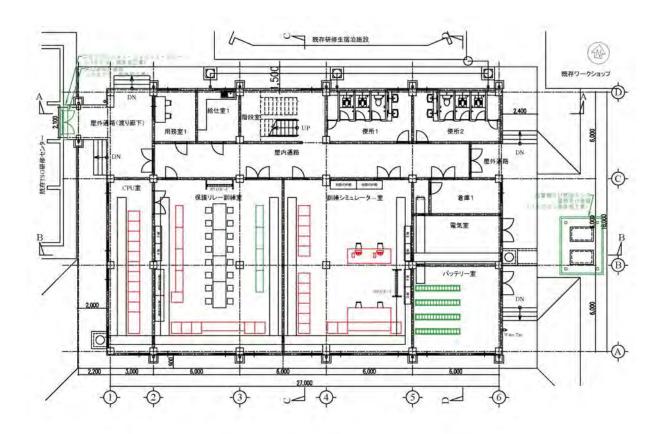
送変電訓練用シミュレーター研修施設 1 階(Ground Floor)配置図
